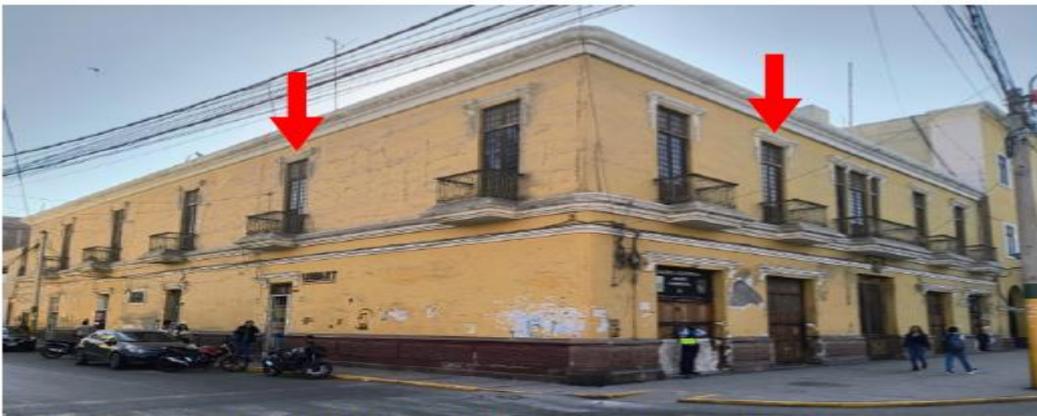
Inmueble ubicado en esquina de calle Libertad con calle Bolívar.
